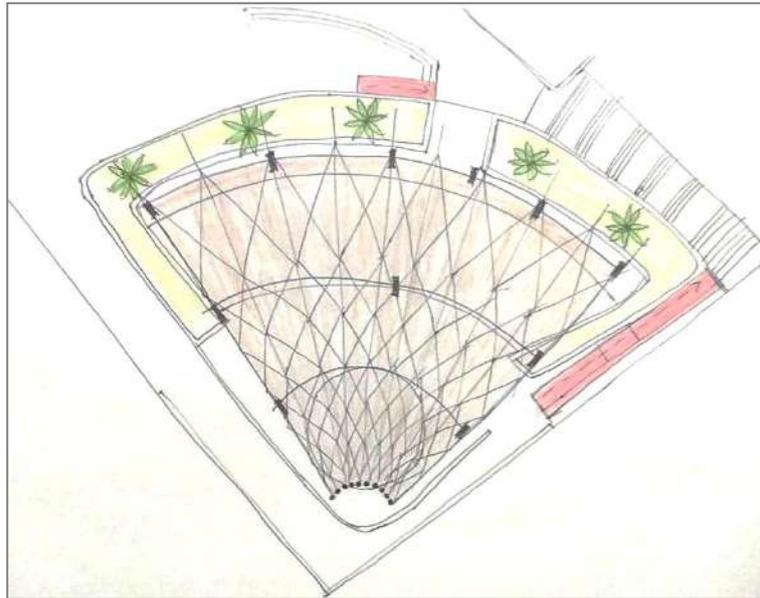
Esboço zona D: acessos, cobertura metálica treliçada, pilares e vigas.
